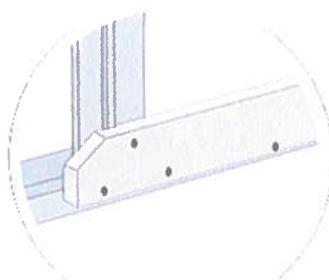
Fixação da placa ao perfil raia e da placa ao perfil montante, separadamente.
